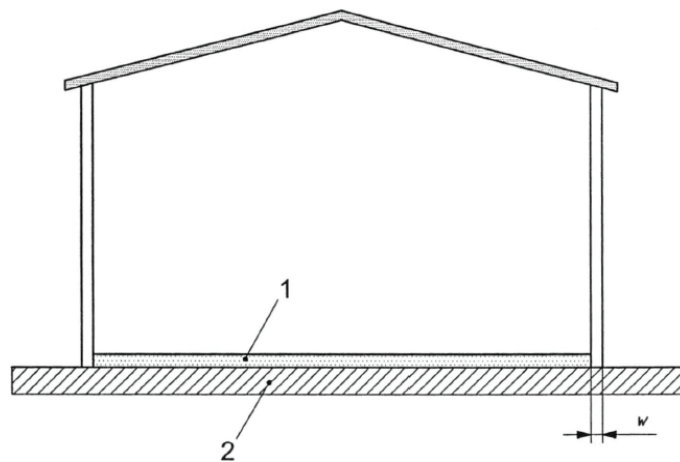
Схема будинку з підлогою першого поверху по ґрунту.
